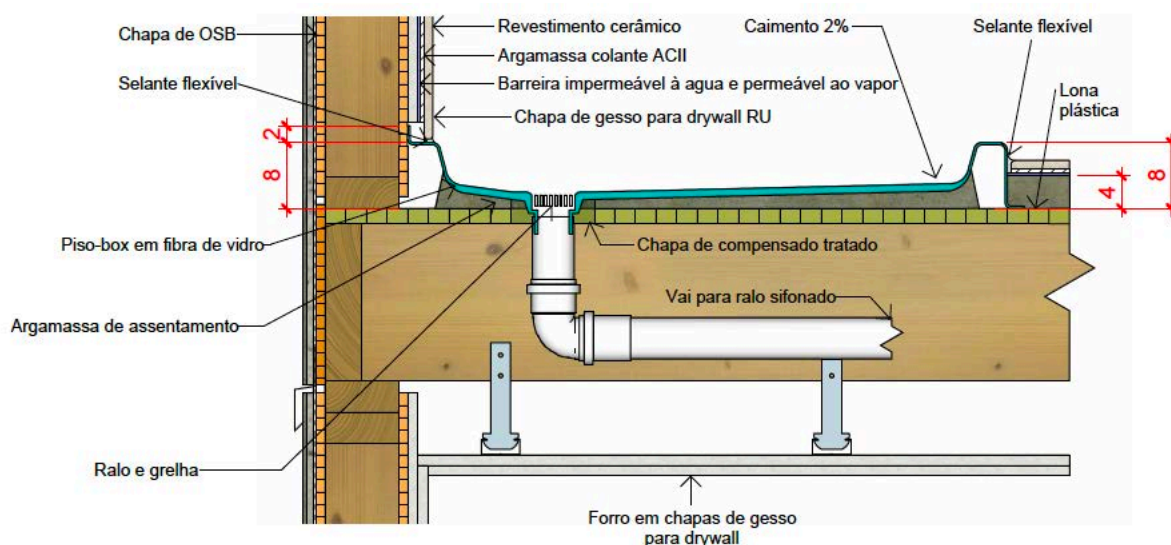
Detalhe em corte do piso box instalado sobre o entrepiso de edificações multifamiliares.
